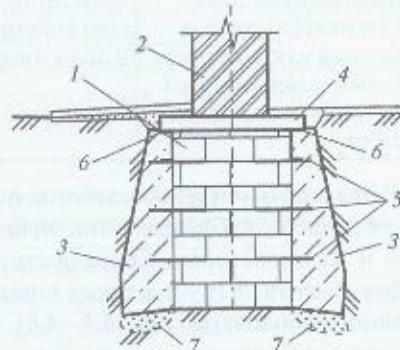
Уширение опорной площади ленточных фундаментов устройством приливов из бетона с установкой металлических балок и штырей:
